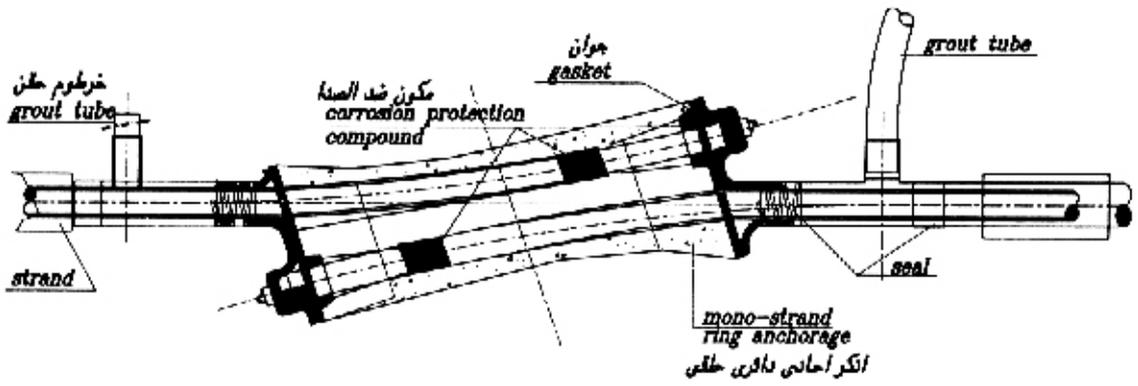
تفصيلة نموذجية ل Anchor متعدد المستويات
